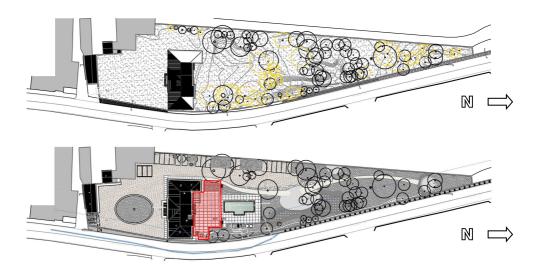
Planimetria generale: confronto fra stato di fatto, sopra e stato di progetto, sotto. In rosso, il vano interrato in progetto
